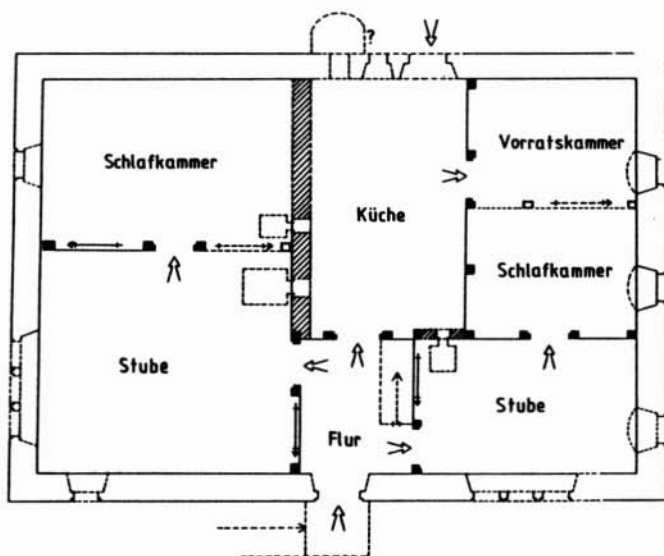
Freiburg-Tiengen, Alte Breisacher Str. 3 (1592 d), Systemgrundriß Erdgeschoss.
